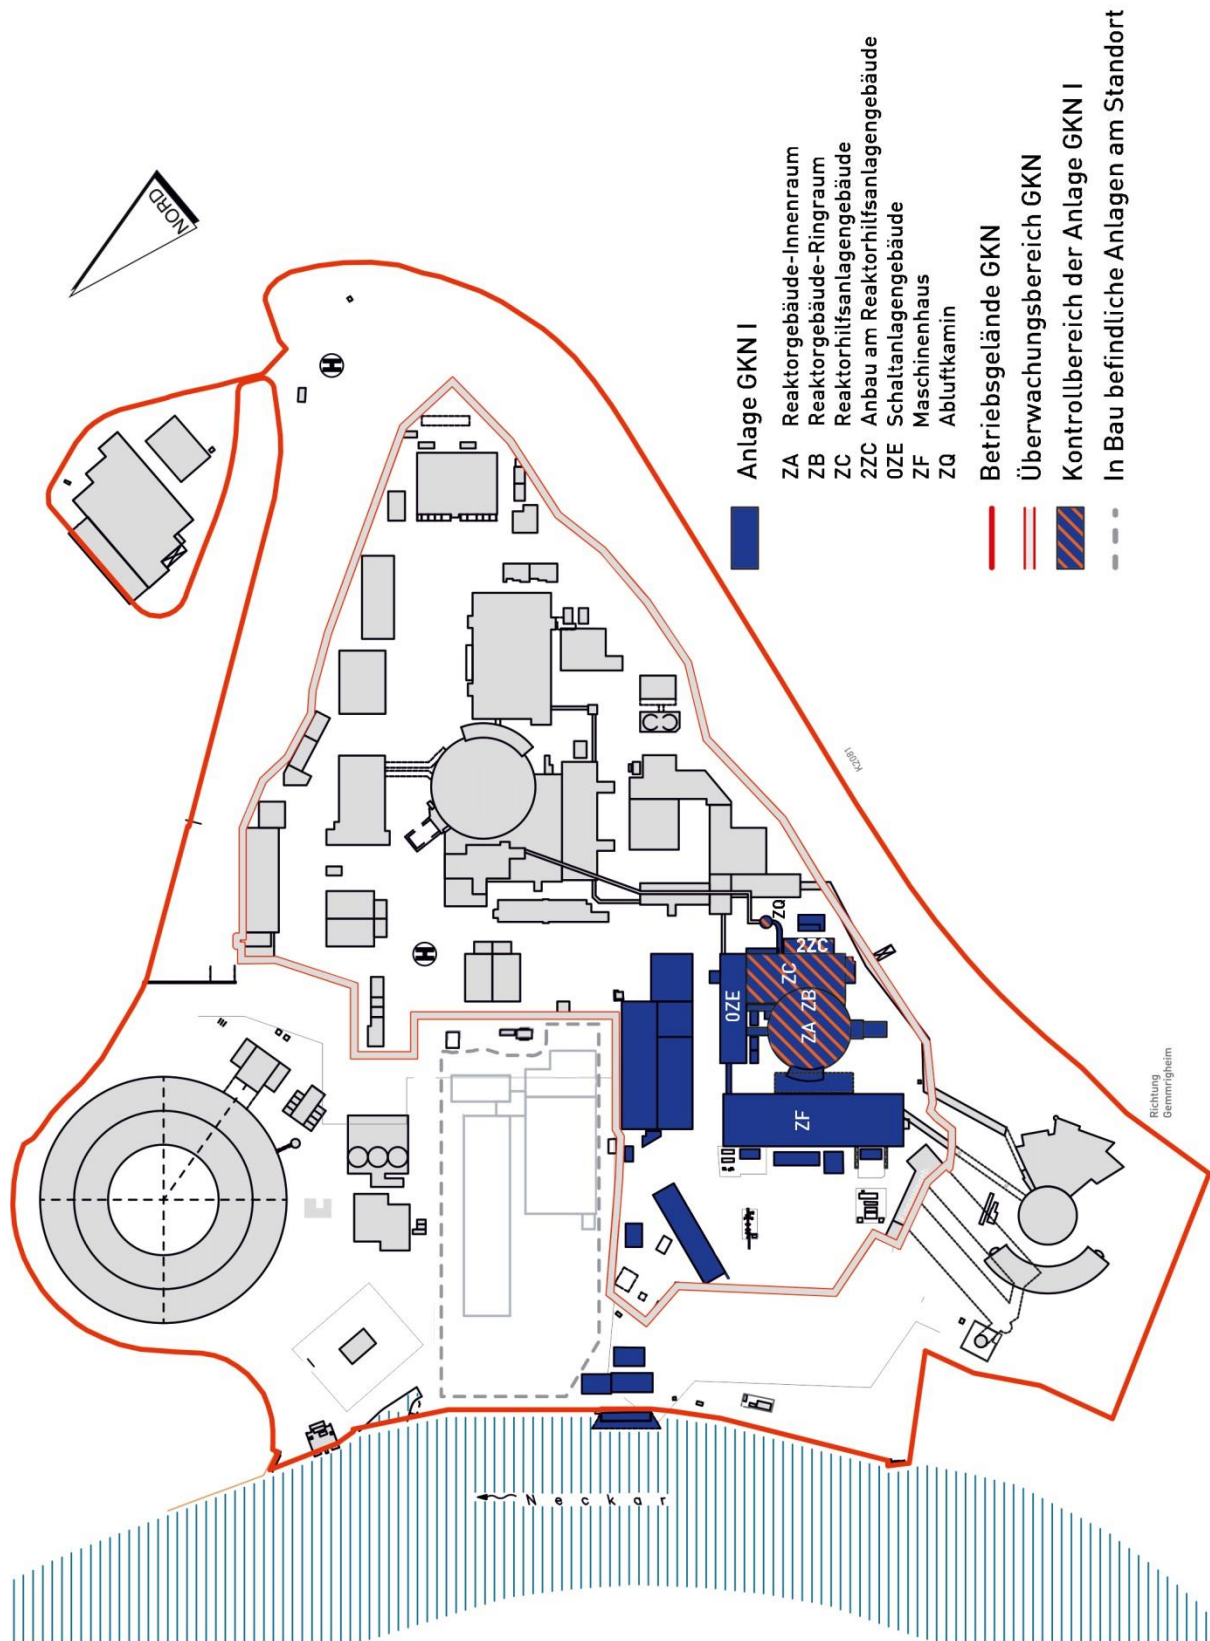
Lageplan des Kernkraftwerks Neckarwestheim
